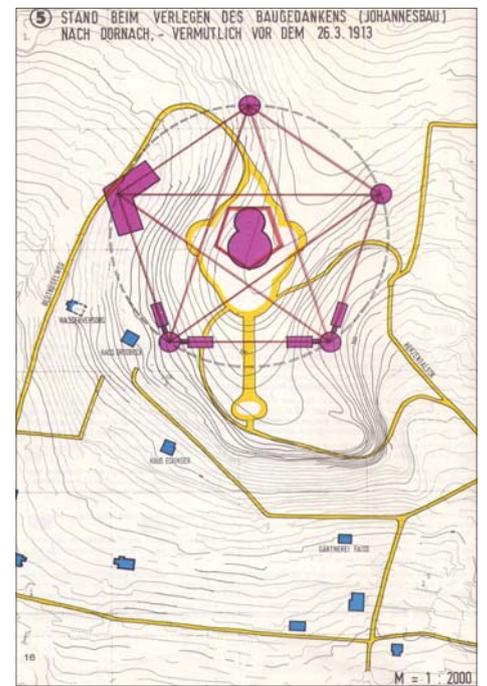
Rudolf Steiner - Planimetria terreno collina di Dornach, Progetto prima del 26.3.1913. Dornach, Svizzera.
